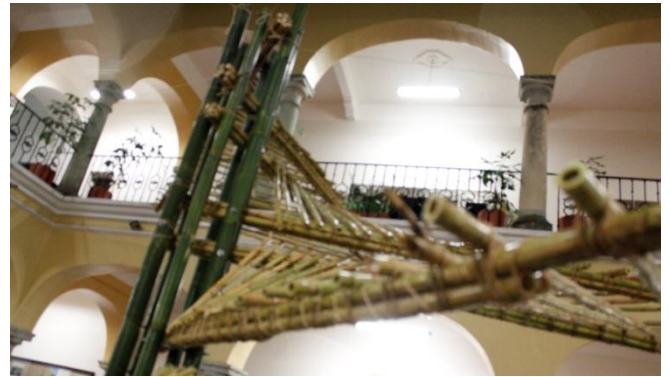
Amarres de los elementos de cobertura a la estructura principal
